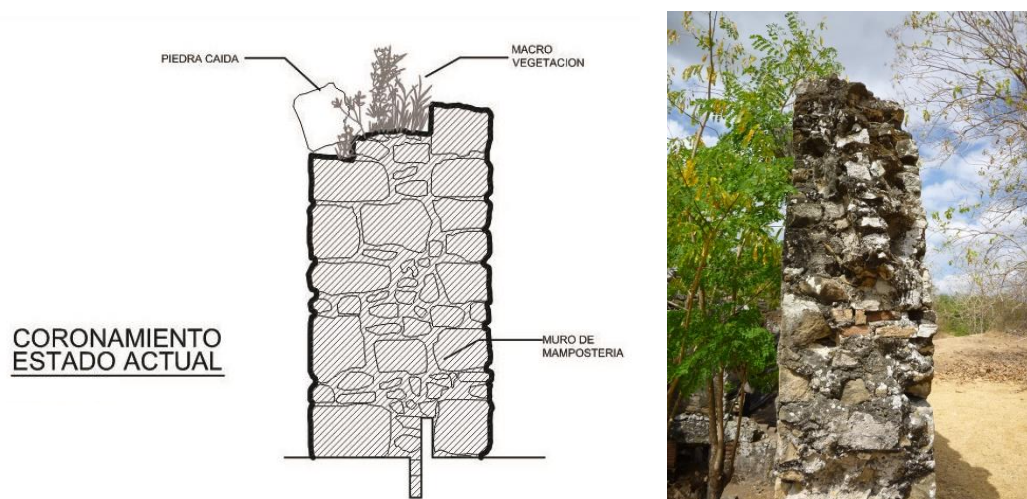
a, sección típica de un muro de mampostería en Panamá Viejo, específicamente muro este de las Casas Reales; b, fotografía de una sección de muro en el área de Casas Reales (Silvia Arroyo – PPV).
